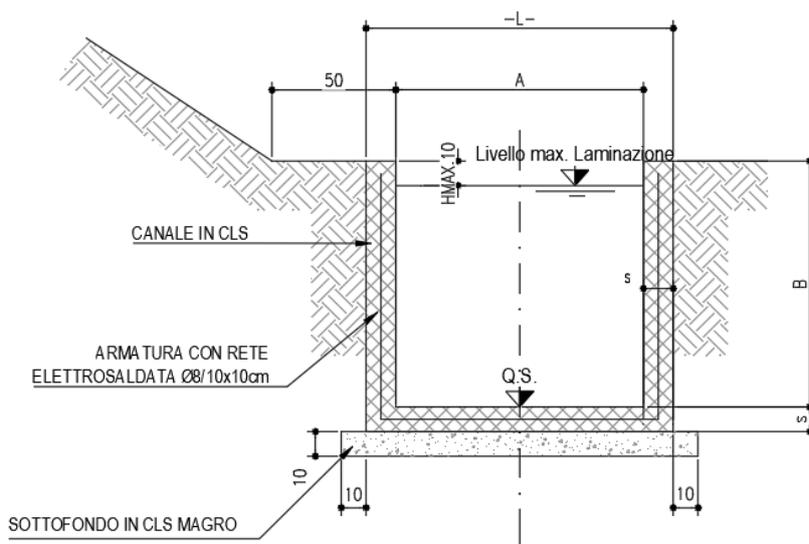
Sezione tipologica dei fossi di laminazione a sezione rettangolare.
